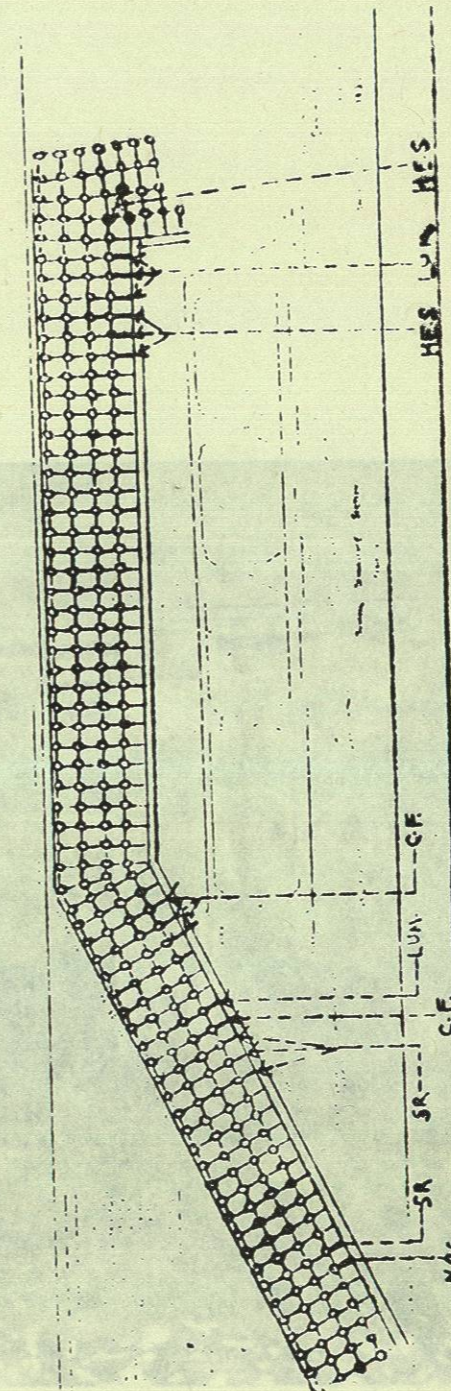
Reconstrucción de los atracaderos 1-3-4-5 - Plan récord, Puerto de St. John, 1936. Muestra la localización de las armaduras y columnas usando cementos especiales. Cemento Portland ordinario C.P.O., resistente a los sulfatos, - R. S., Cemento FONAL L.U.M. - Lumite, Alta resistencia inicial (Records históricos, Puerto St. John, Canada Cement Lafarge Ltd.).
